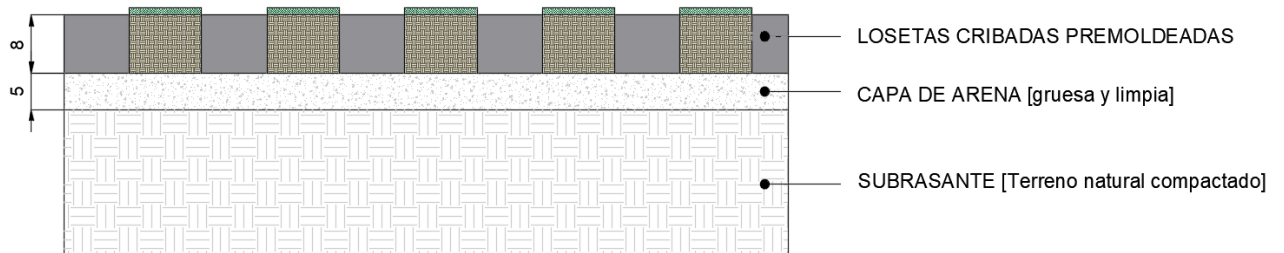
Pavimento intertrabado verde - Dársena de estacionamiento. Fuente: Elaboración propia.
